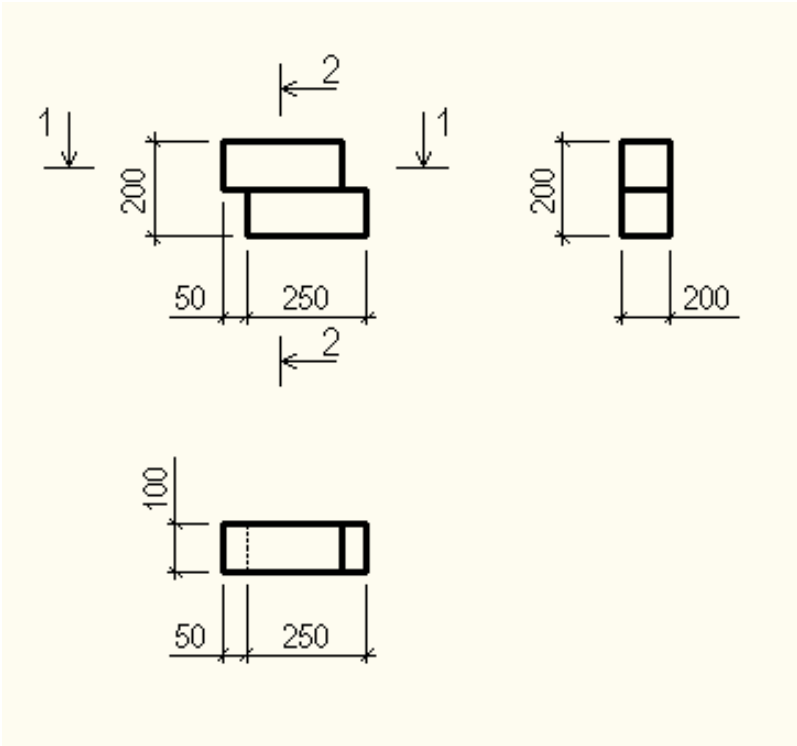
Размеры образцов для испытаний на сдвиг
